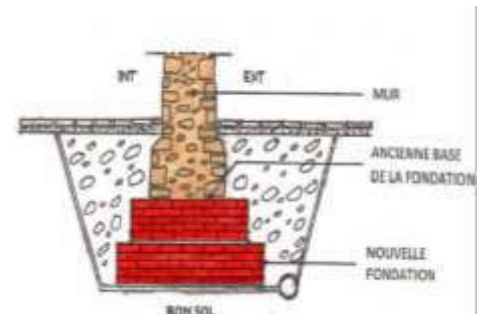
consolidation d'une fondation en sous œuvre en maçonnerie
